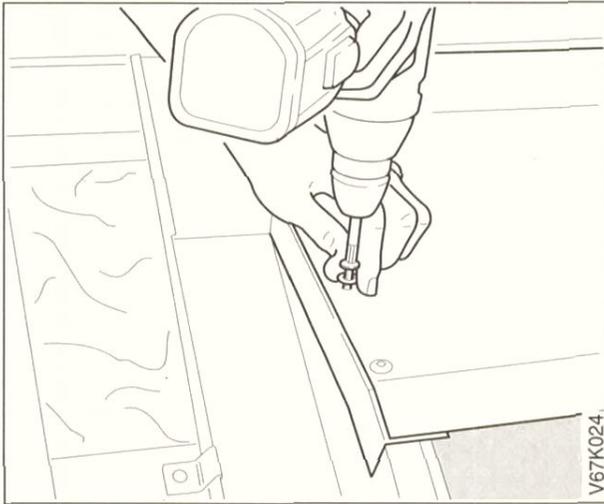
Ecken mit oberem Abschlussblech am Rand mit jeweils 3 Sprengerschrauben (selbstschneidende Schrauben) mit Unterlegscheiben verbinden.
